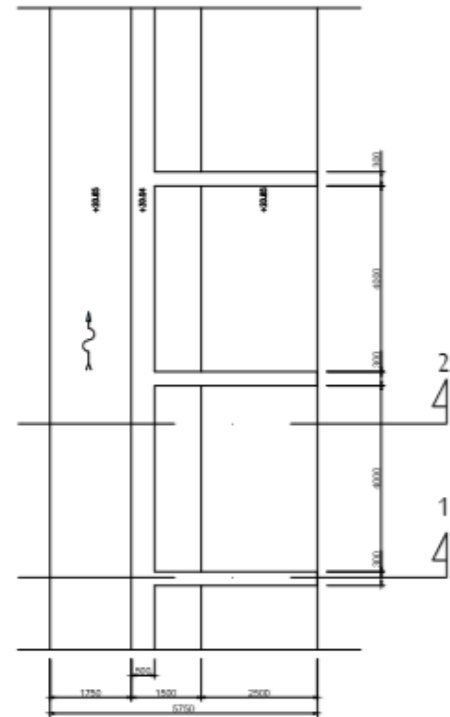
Denah Tampak Atas Dinding Penahan Tanah Bendung Kamijoro
